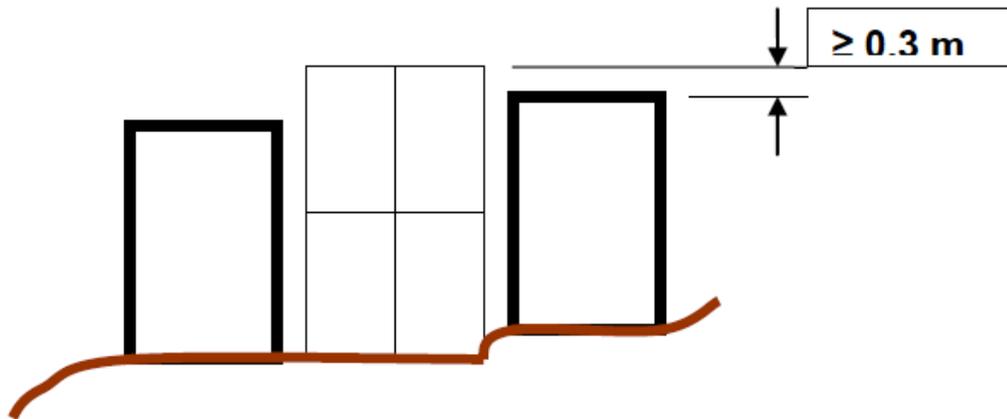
Détermination de la hauteur minimum d'une barricade.
